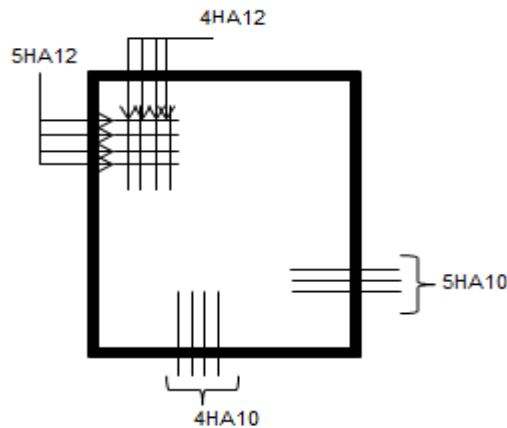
Schéma de ferrailage de la dalle pleine (D2)
